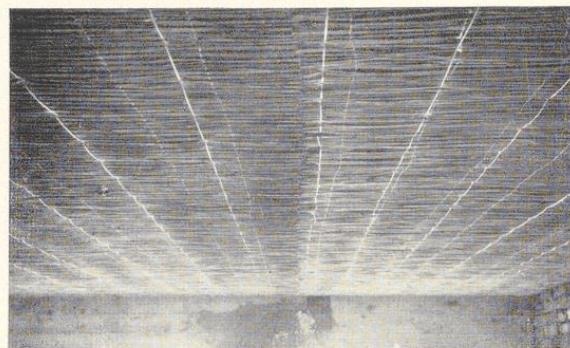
Bespannung einer Decke mit Doppelrohrmatten und Ziehen besonderer Spanndrähte
